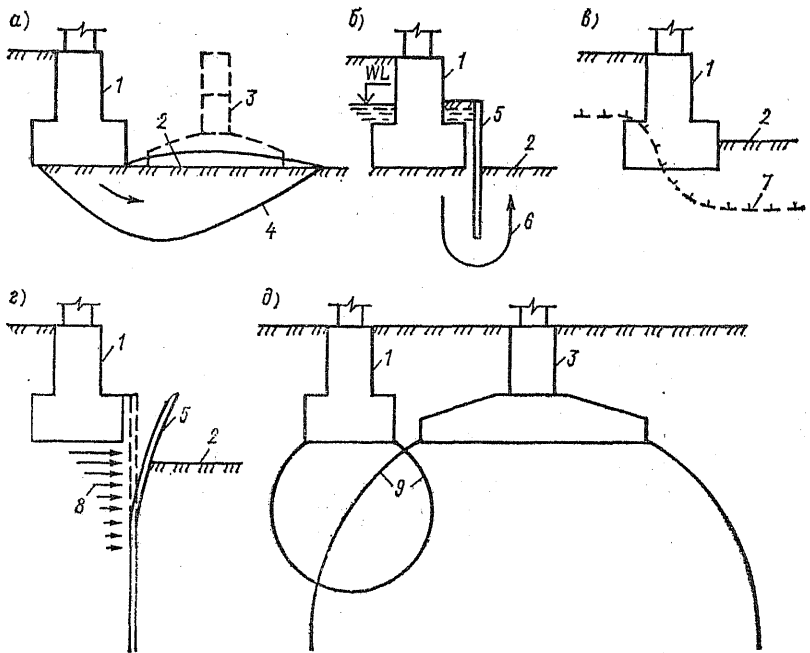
Случаи развития дополнительных осадок существующих зданий при возведении около них фундаментов
